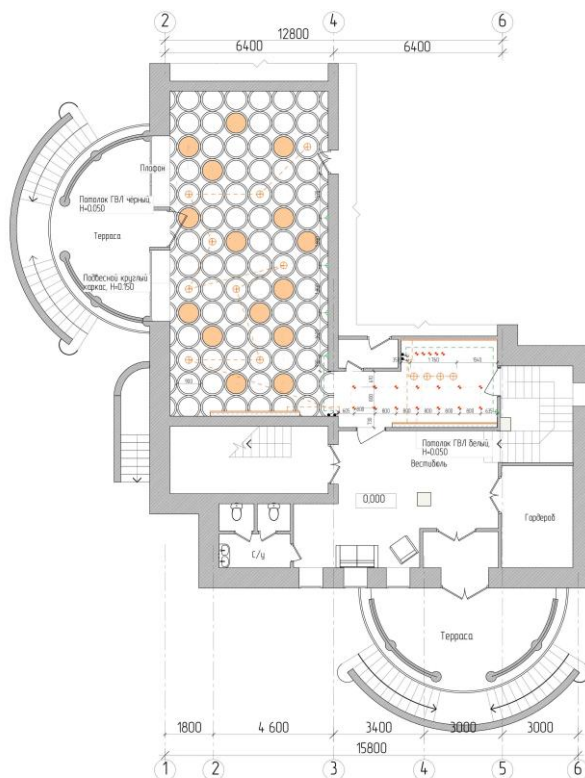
План потолка с расстановкой осветительного оборудования фрагмента 1 – го этажа (ресторан и бар)
